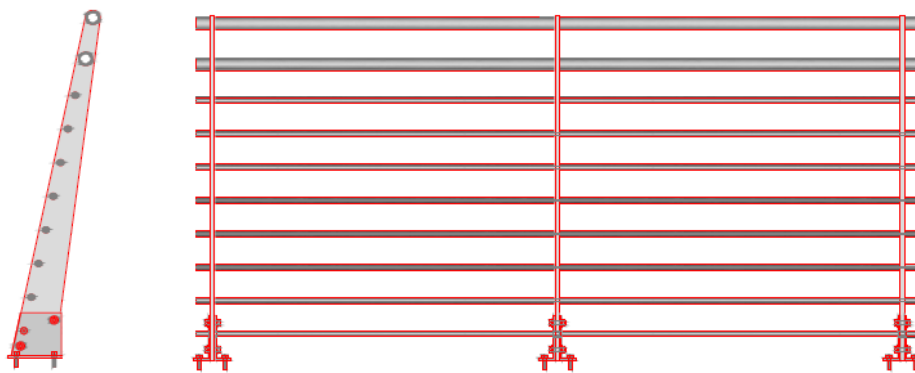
c: Sezione e prospetto parapetto in progetto
